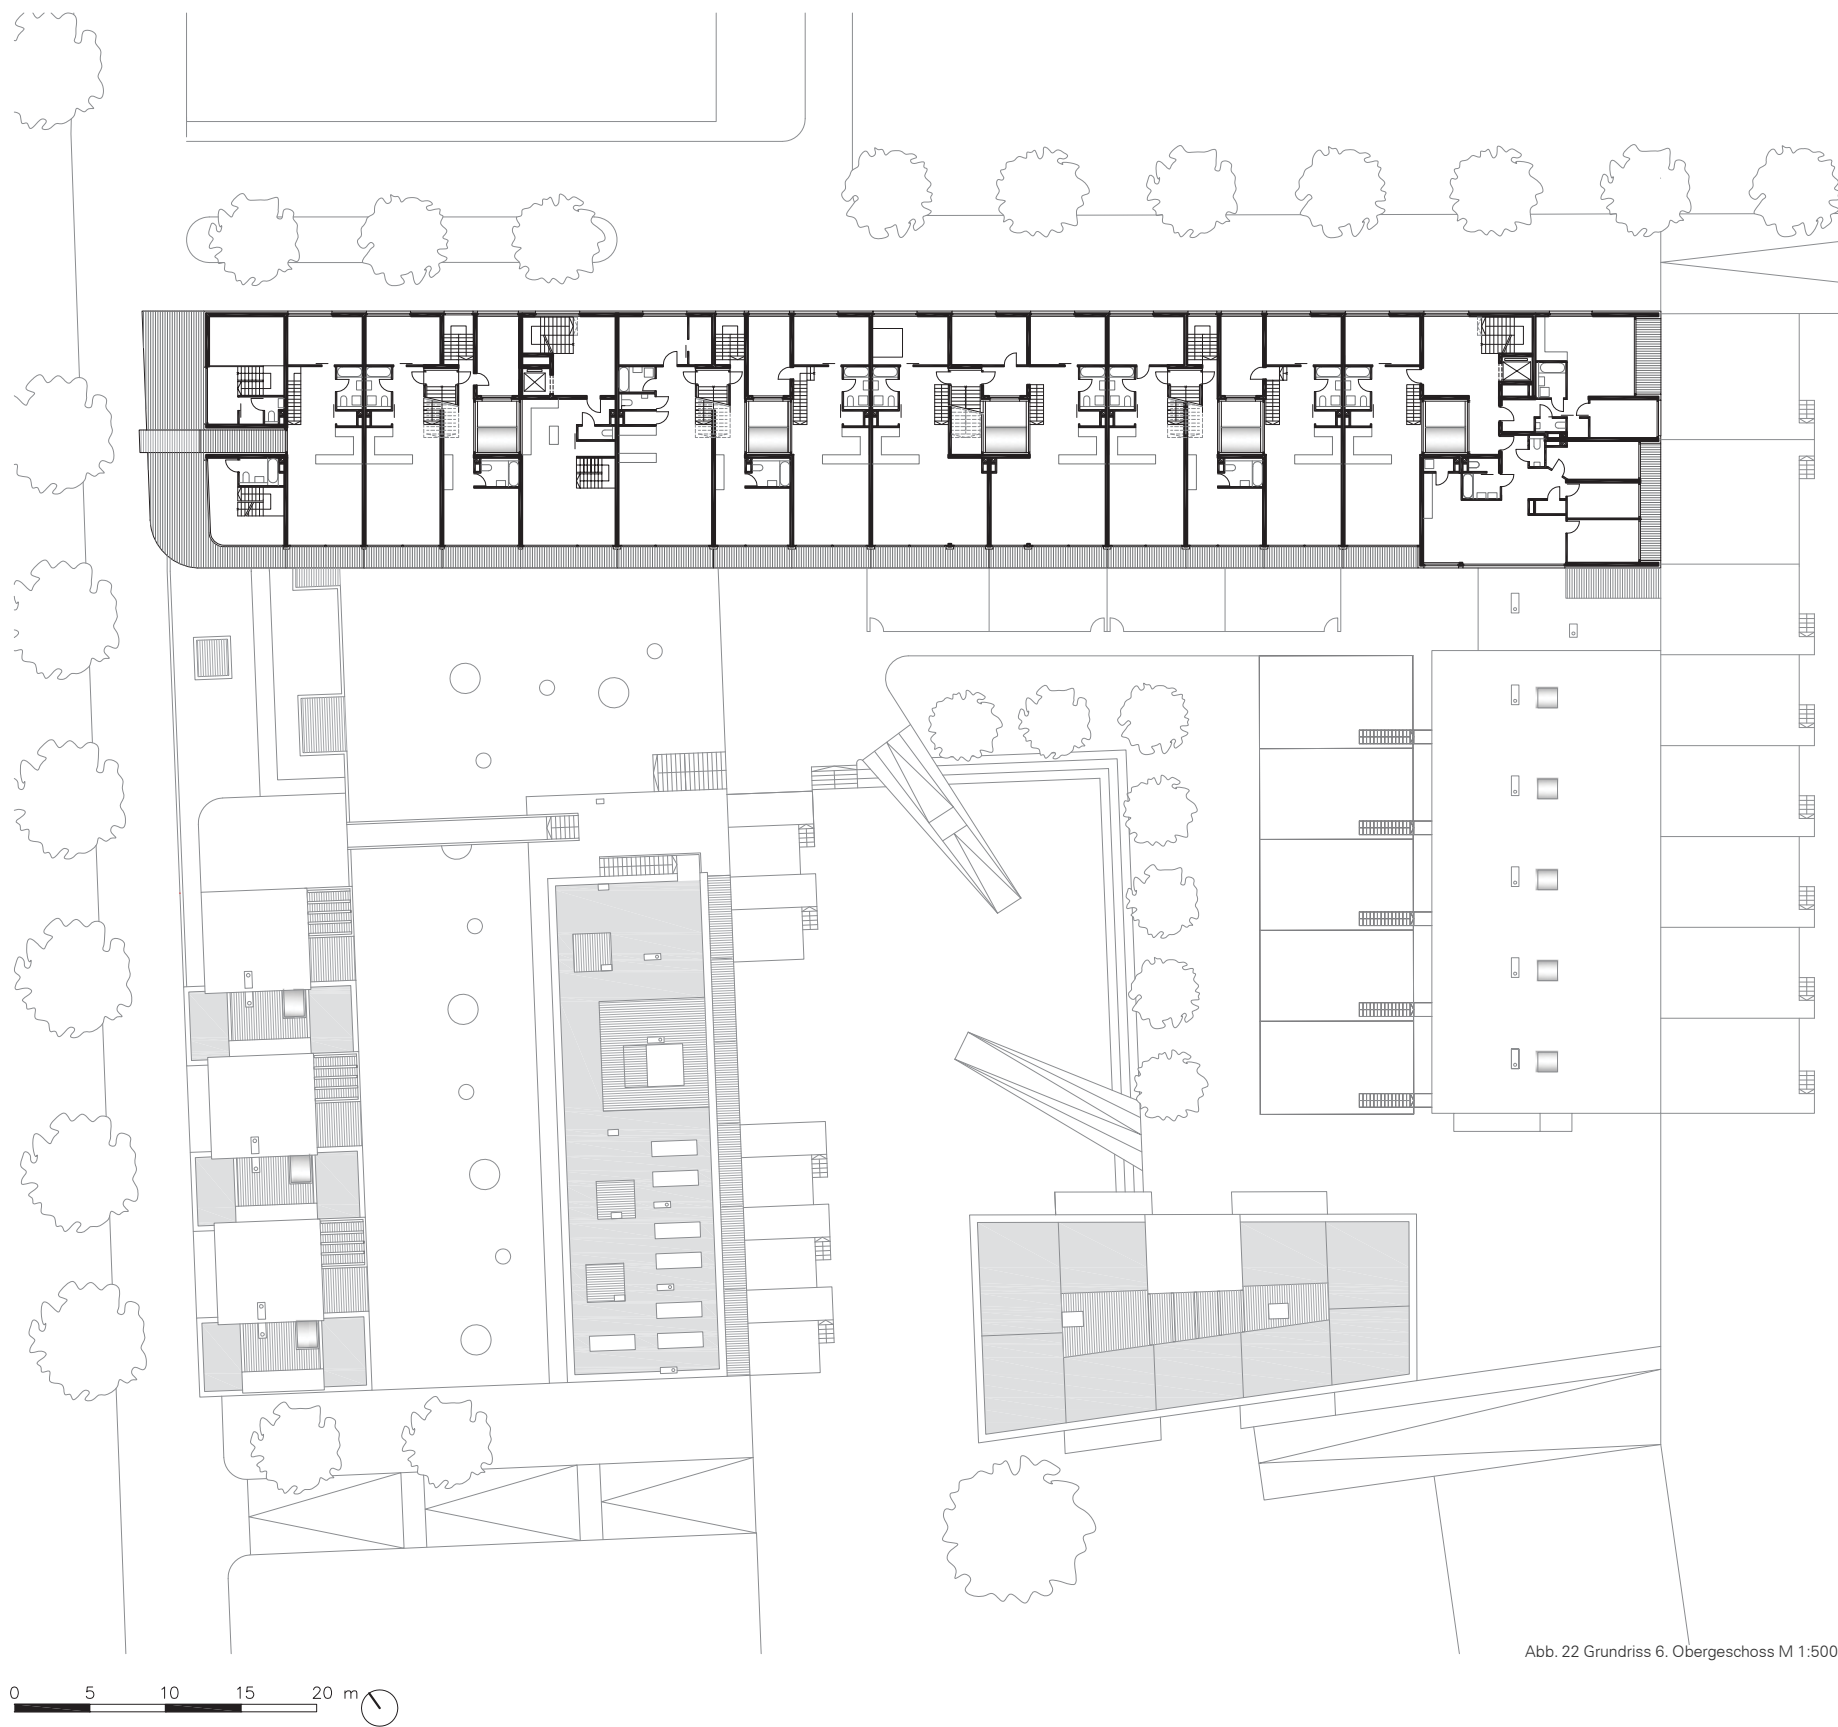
Grundriss 6. Obergeschoss M 1:500
